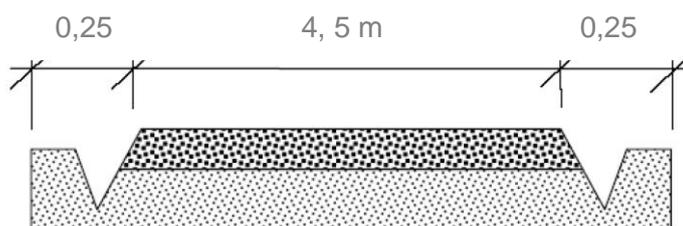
VUE EN COUPE D'UNE PISTE D'ACCES.
